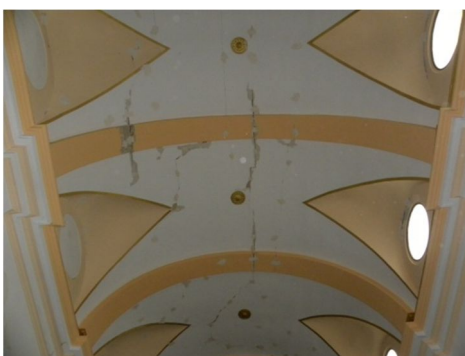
Fisuras y grietas presentes en la bóveda de la nave central.
